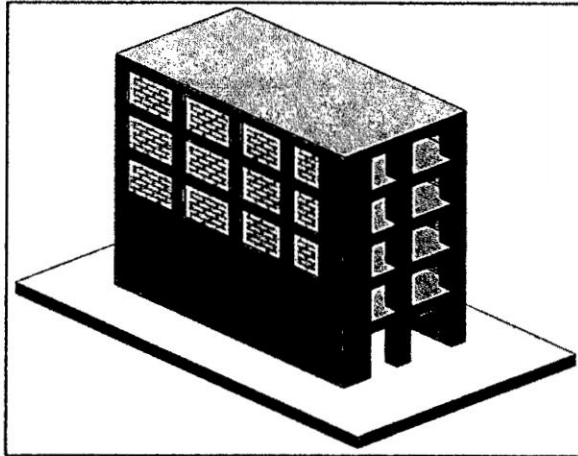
Detalle en planta y elevación de Muro relleno (Diafragma)
